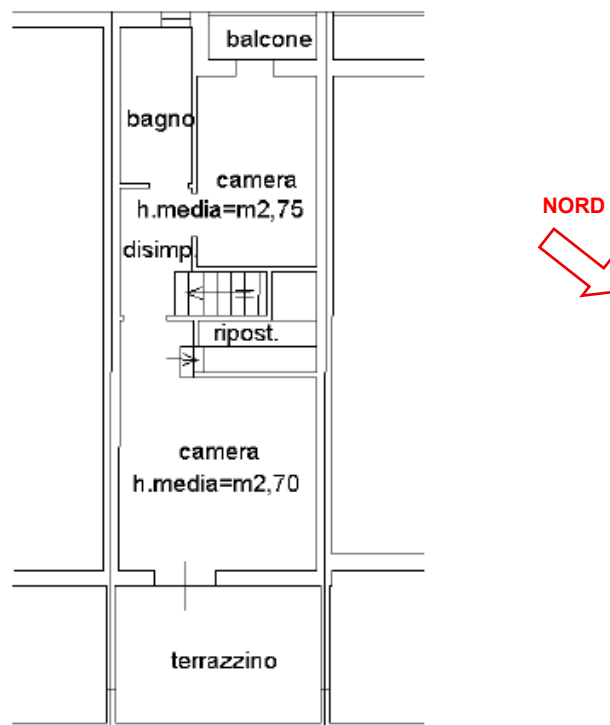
Stralcio planimetria catastale in atti (fuori scala). Piano primo
